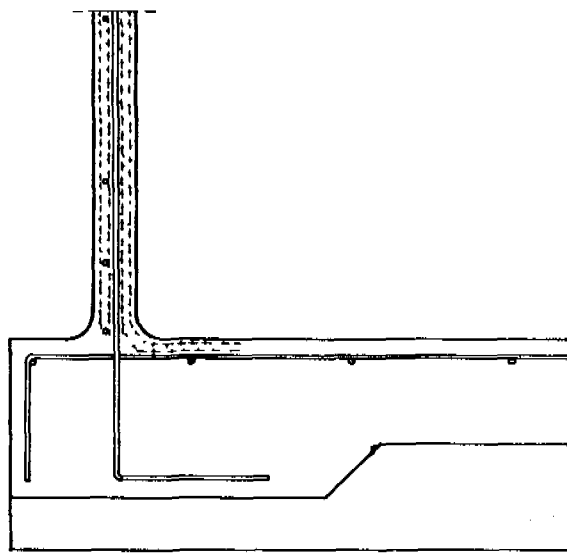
Conexión de la pared y el piso en ferrocemento y hormigón reforzado.
